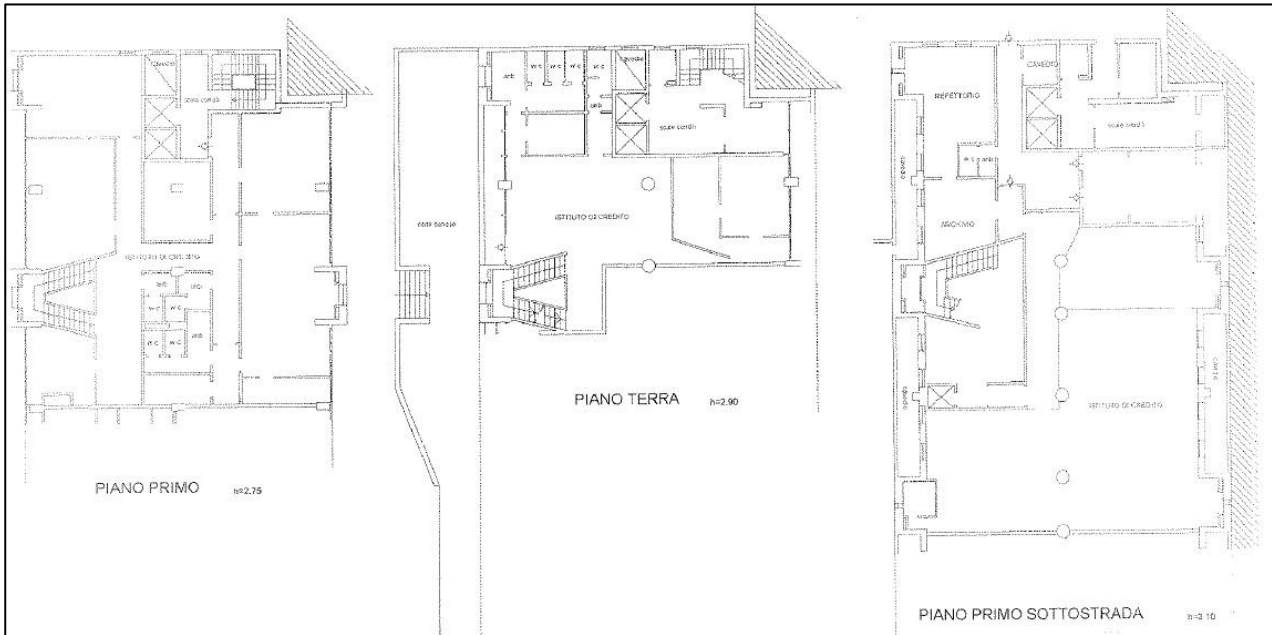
planimetria dell’unità ad uso ufficio (piano terra e 1° piano) ed archivio (piano S1)
